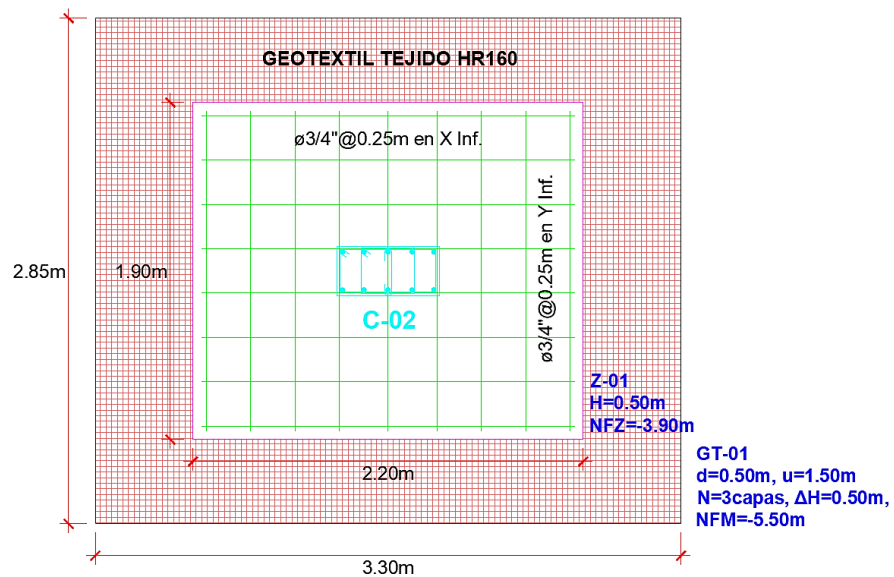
Detalle del mejoramiento de suelos con geotextil de la zapata aislada vista en planta
